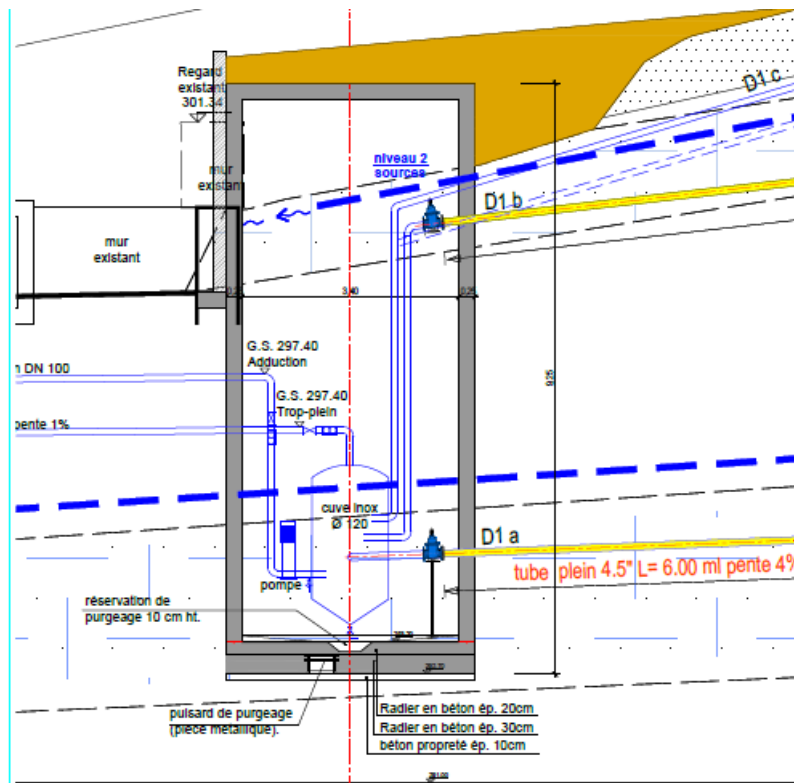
Plan schématique „Captage D1 Dommeldange- Concept d'assainissement (AVP)“, Coupe, Détail 1 (Géoconseils 2014)
